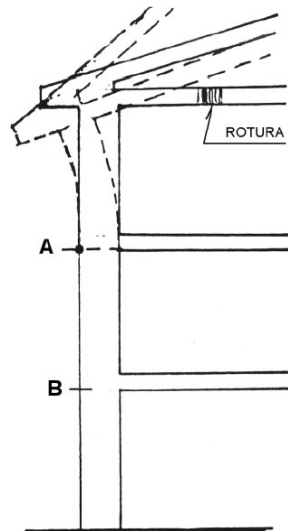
Rotación de la parte superior de una columna (López, Rodríguez, Santa Cruz, et al, 2004).
